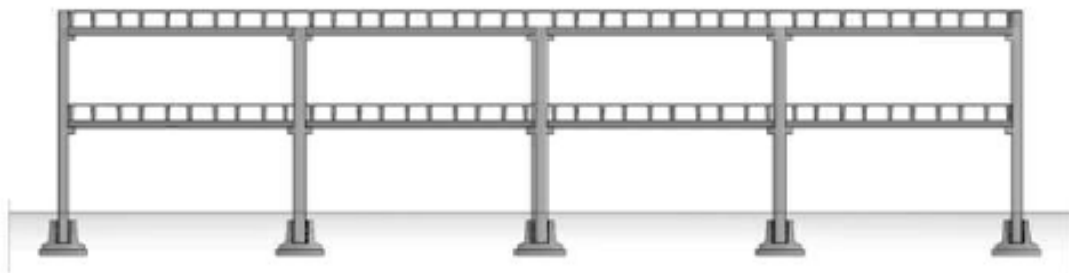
Esempio di edificio prefabbricato pluriplano senza controventi
